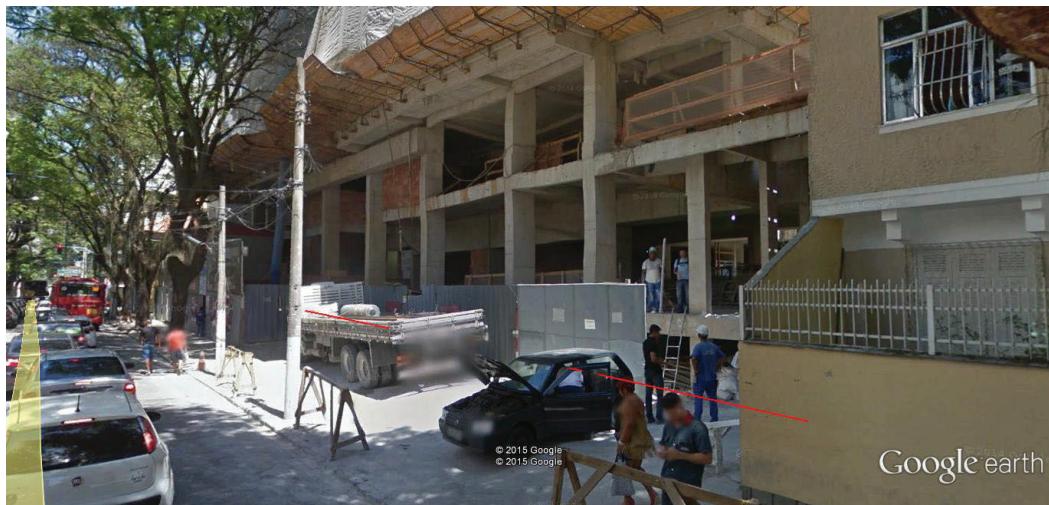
Descarga de material dentro do canteiro de obras nas proximidades do Empreendimento
